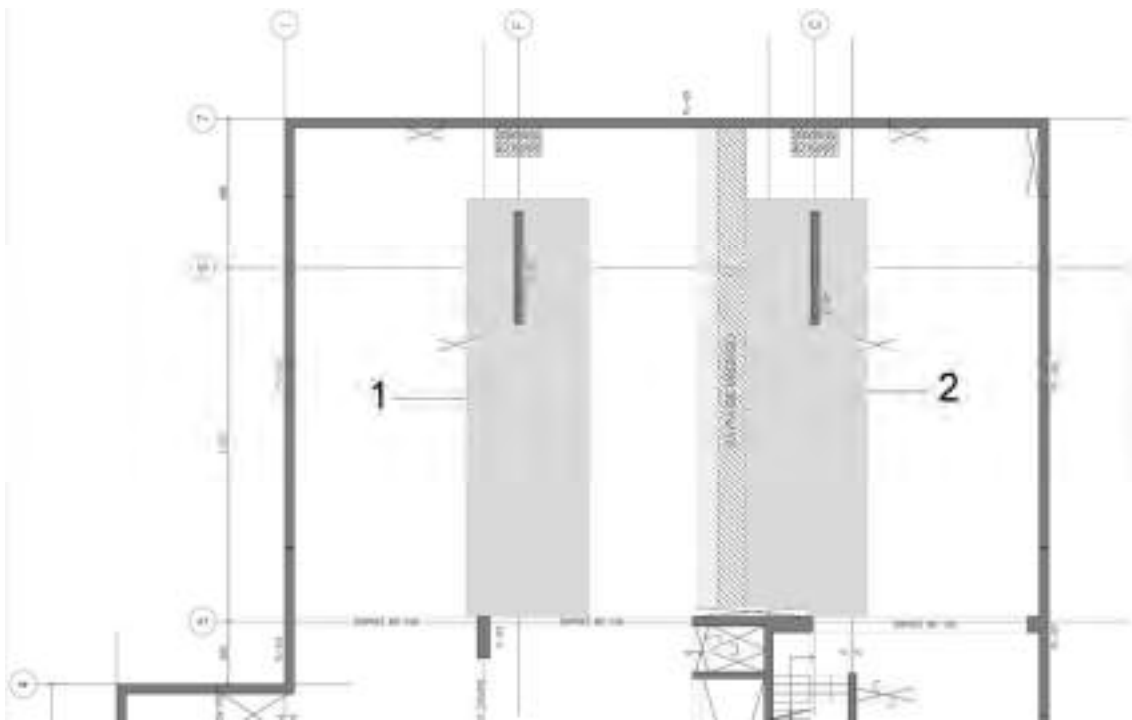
Ubicación de fisuras en semisótano 2
